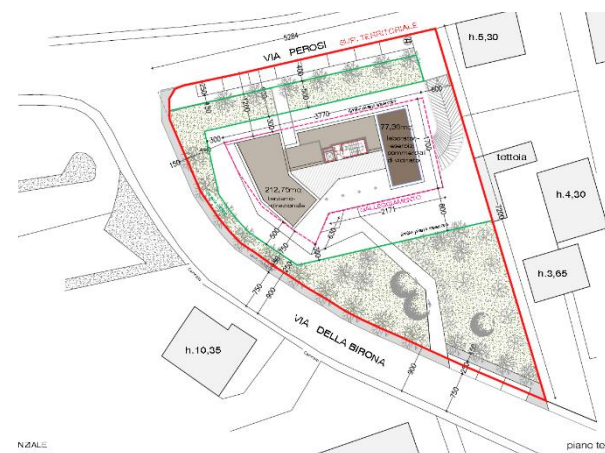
Planimetria intervento P.A. Birona-Perosi
